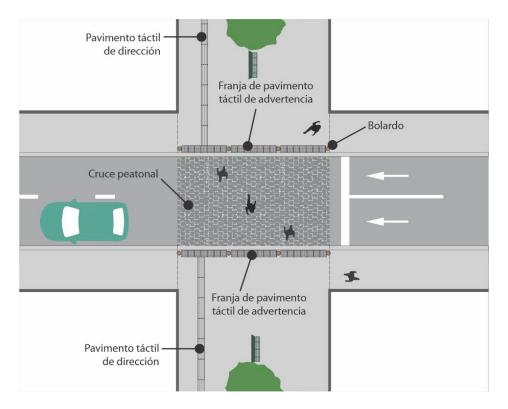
Ruta táctil en cruce peatonal a mitad de cuadra, en banquetas sin pavimento táctil de dirección.
